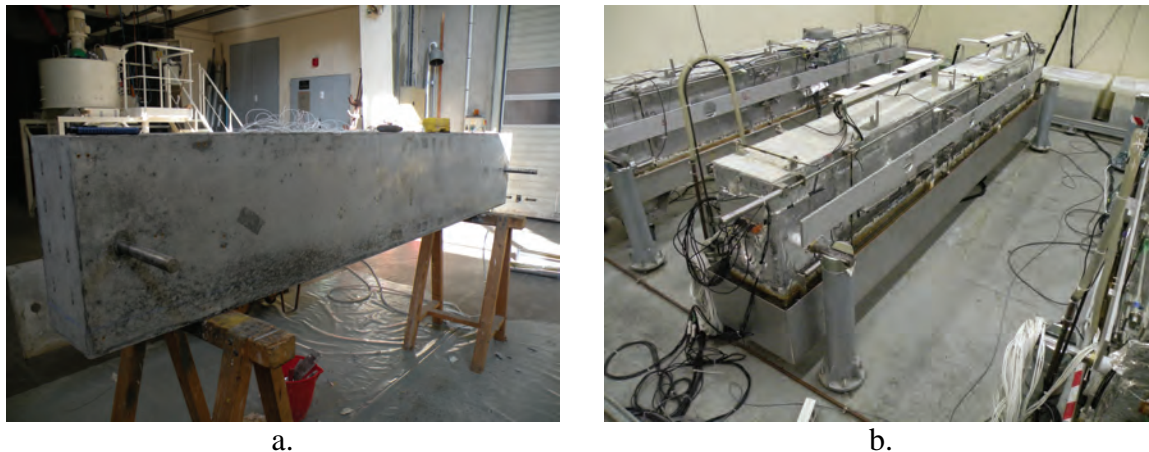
dispositifs d'appui des poutres (a. barres d'appui après décoffrage ; b. poutre en position sur ses appuis glissants)
